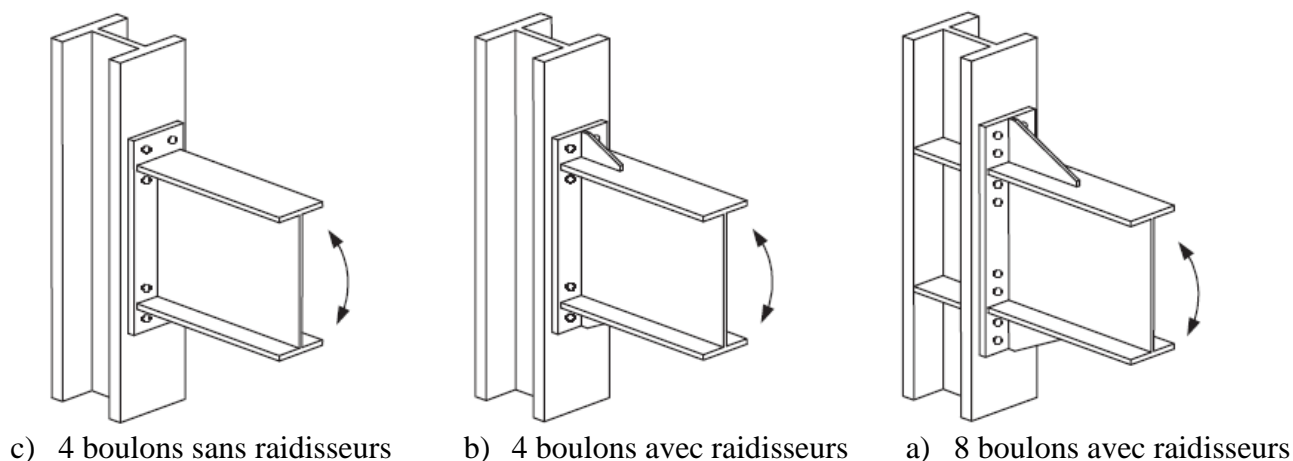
Configurations d'assemblage poutre-poteau selon AISC [27]
